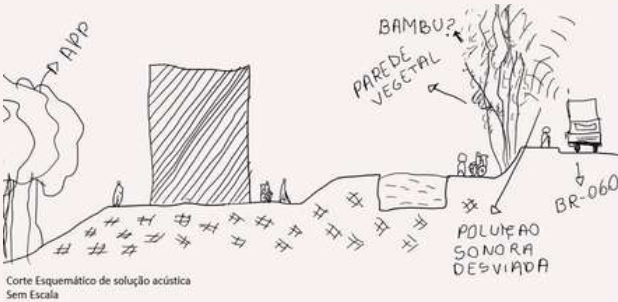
Croqui - teste. Corte transversal preliminar esquemático sobre barreira vegetativa.
